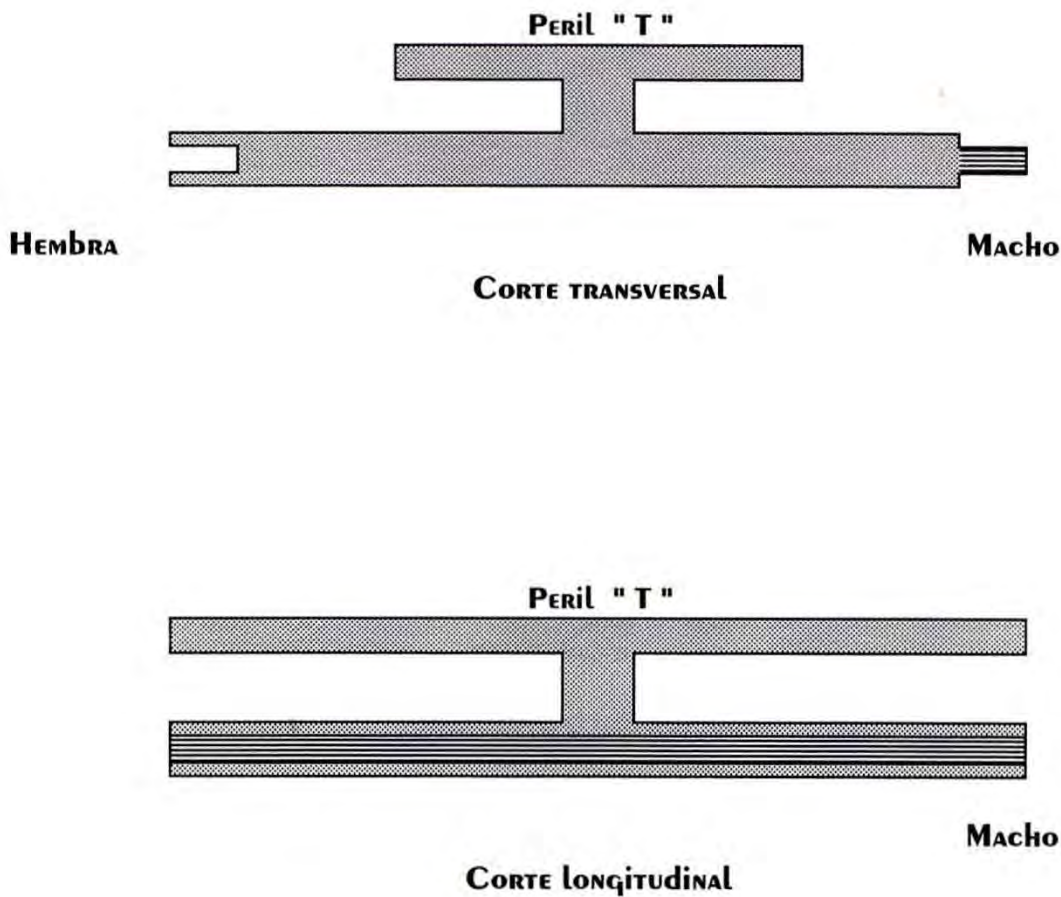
Corte transversal y longitudinal del perfil tipo de la tubería de pvc. Riblock
